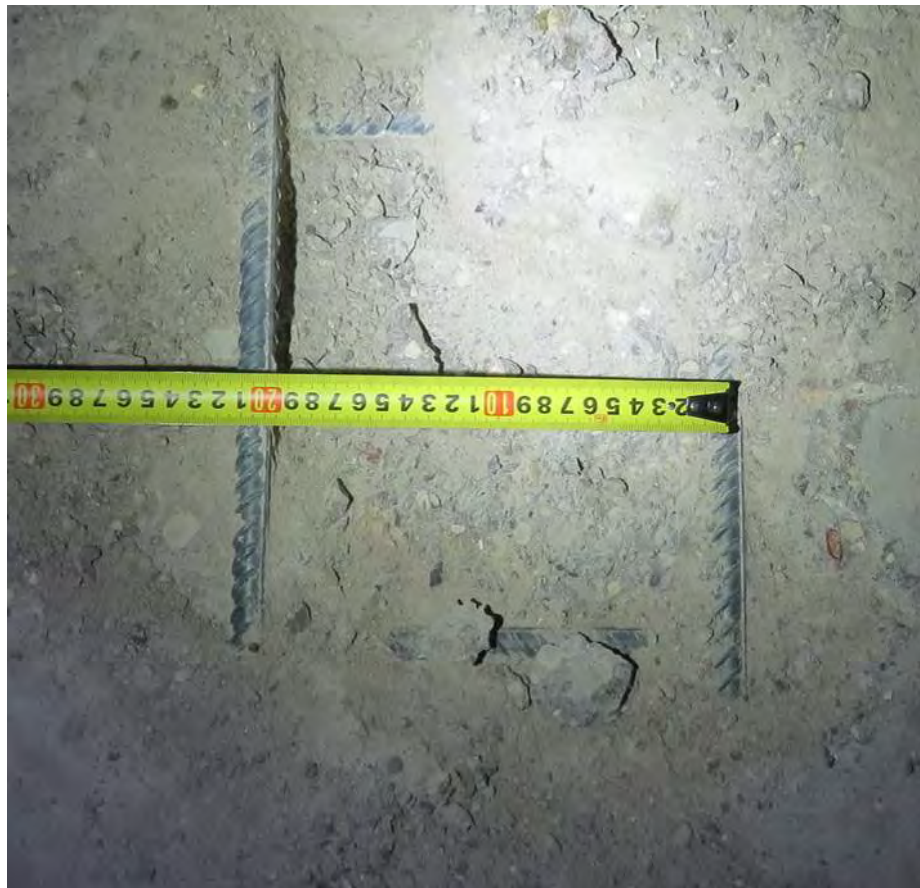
Общий вид вскрытия фундаментной плиты в секции 4 между осями Г/2 – А/2, 27/2-28/2
